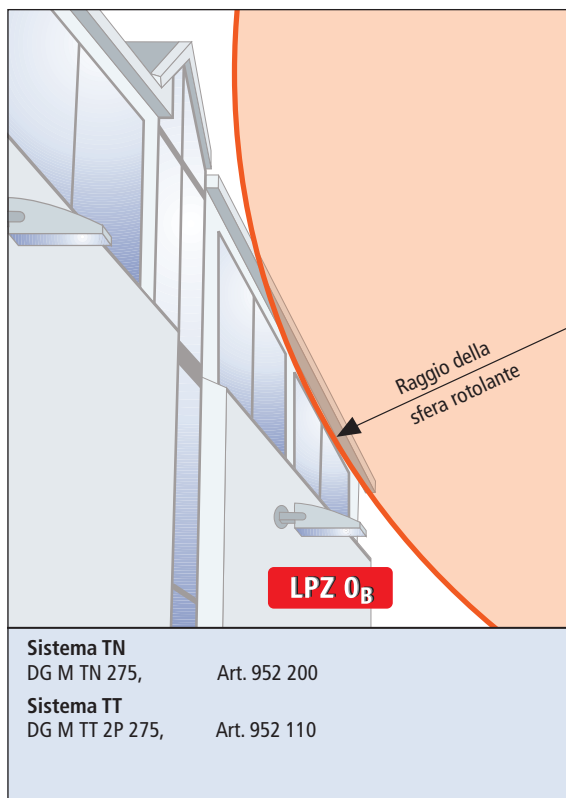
Corpo illuminante esterno 230 V a parete in zona di protezione da fulminazione O_B
